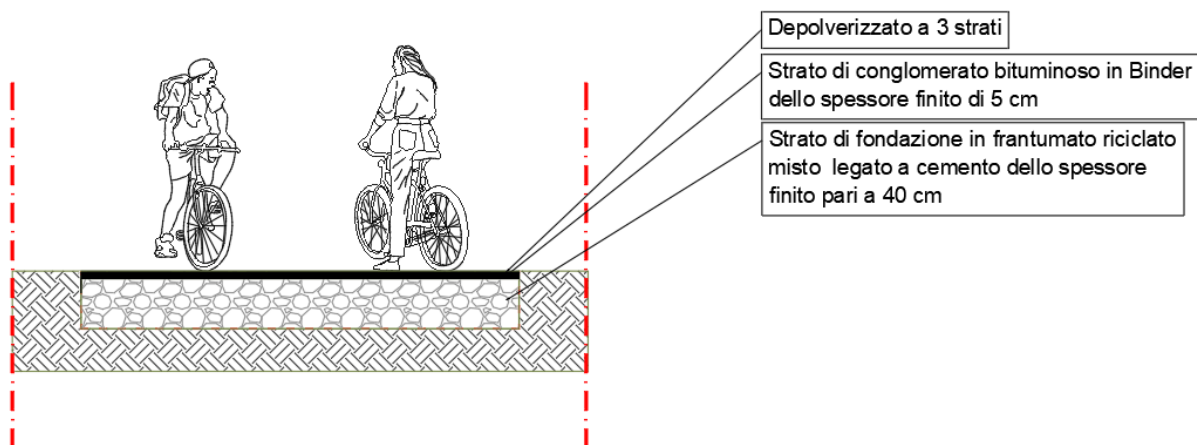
Stratigrafia della pavimentazione in depolverizzato a tre strati
